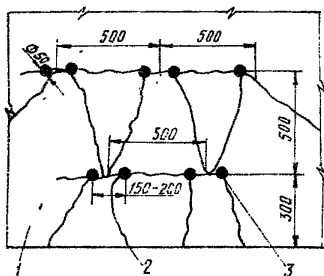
Характер разрушения бетонного фундамента с предварительно пробуренными отверстиями (шпурами)
